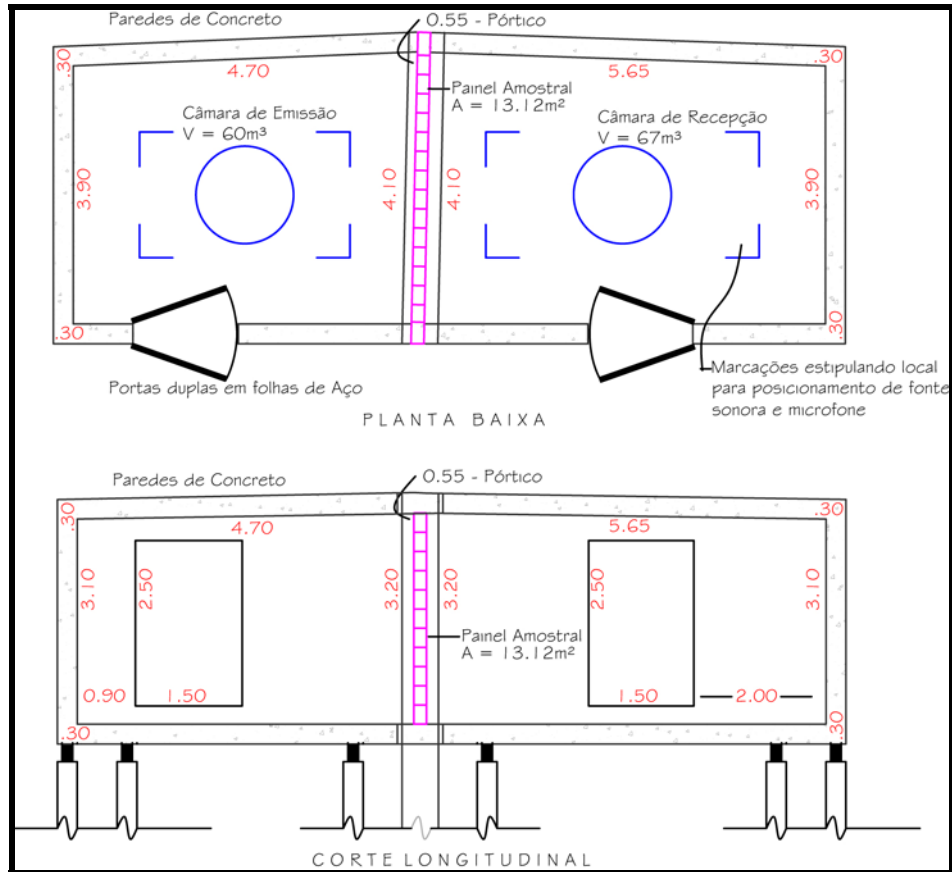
esquema em planta baixa e corte longitudinal das câmaras reverberantes da UFSM.
